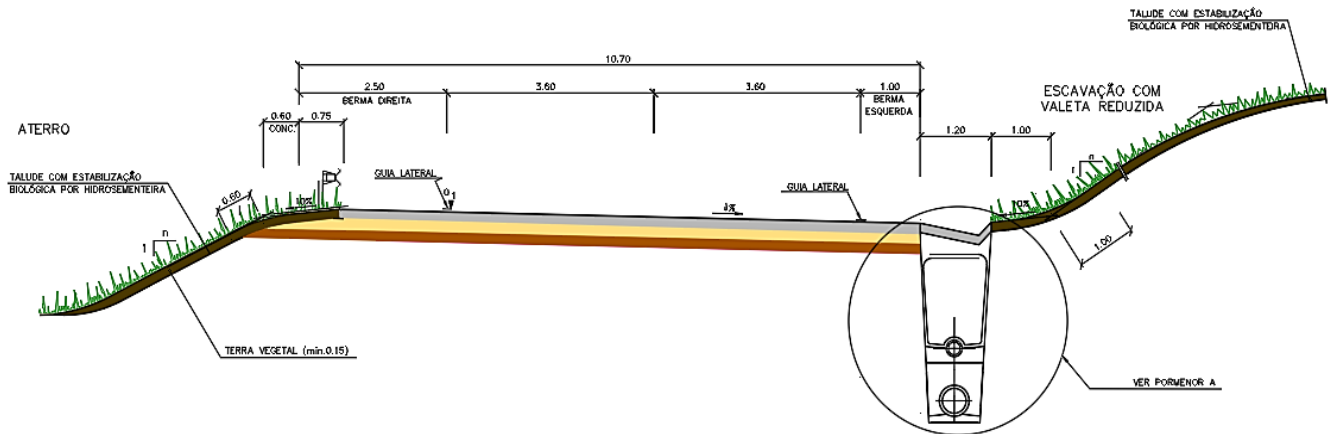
Perfil Transversal Tipo na Zona de Construção Nova em Reta e em Curva
